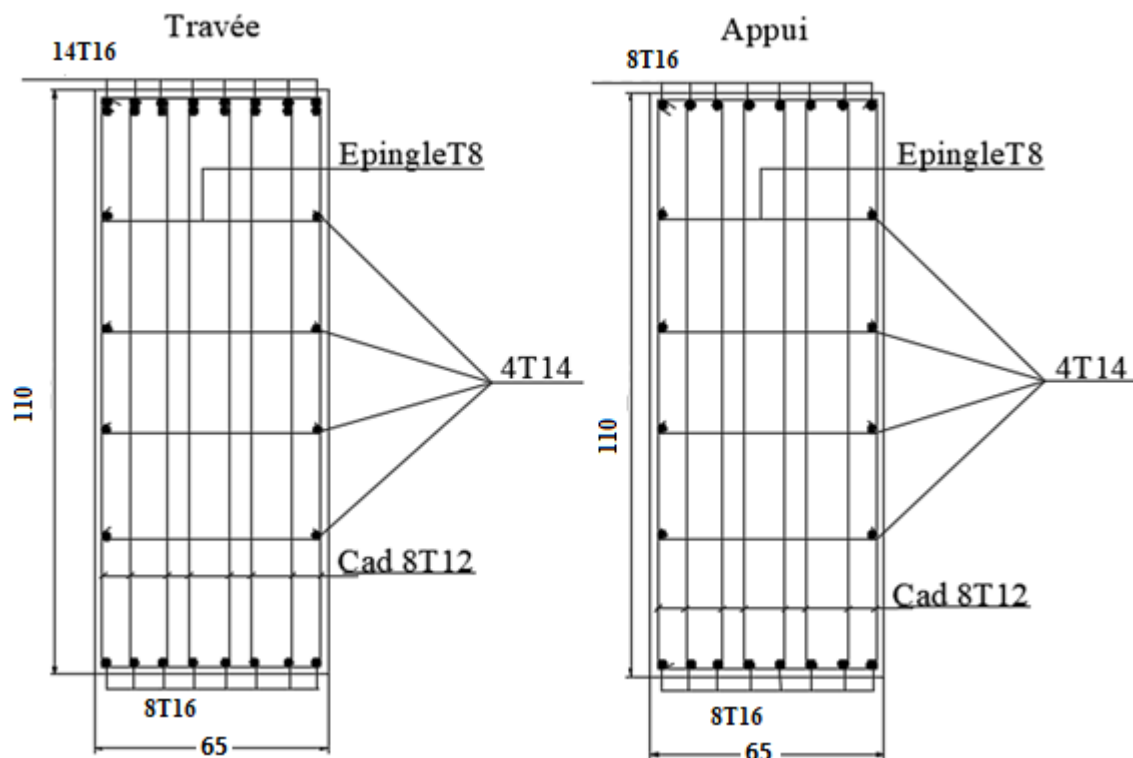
Schéma de ferrailage des nervures (sens Y).
